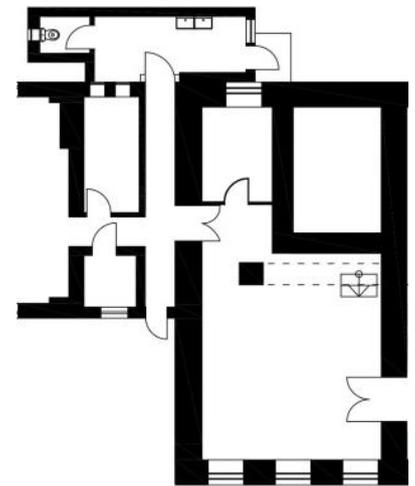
Grundriss Verbindungs- und Sanitärraum Zimmerei - Schlosserei
